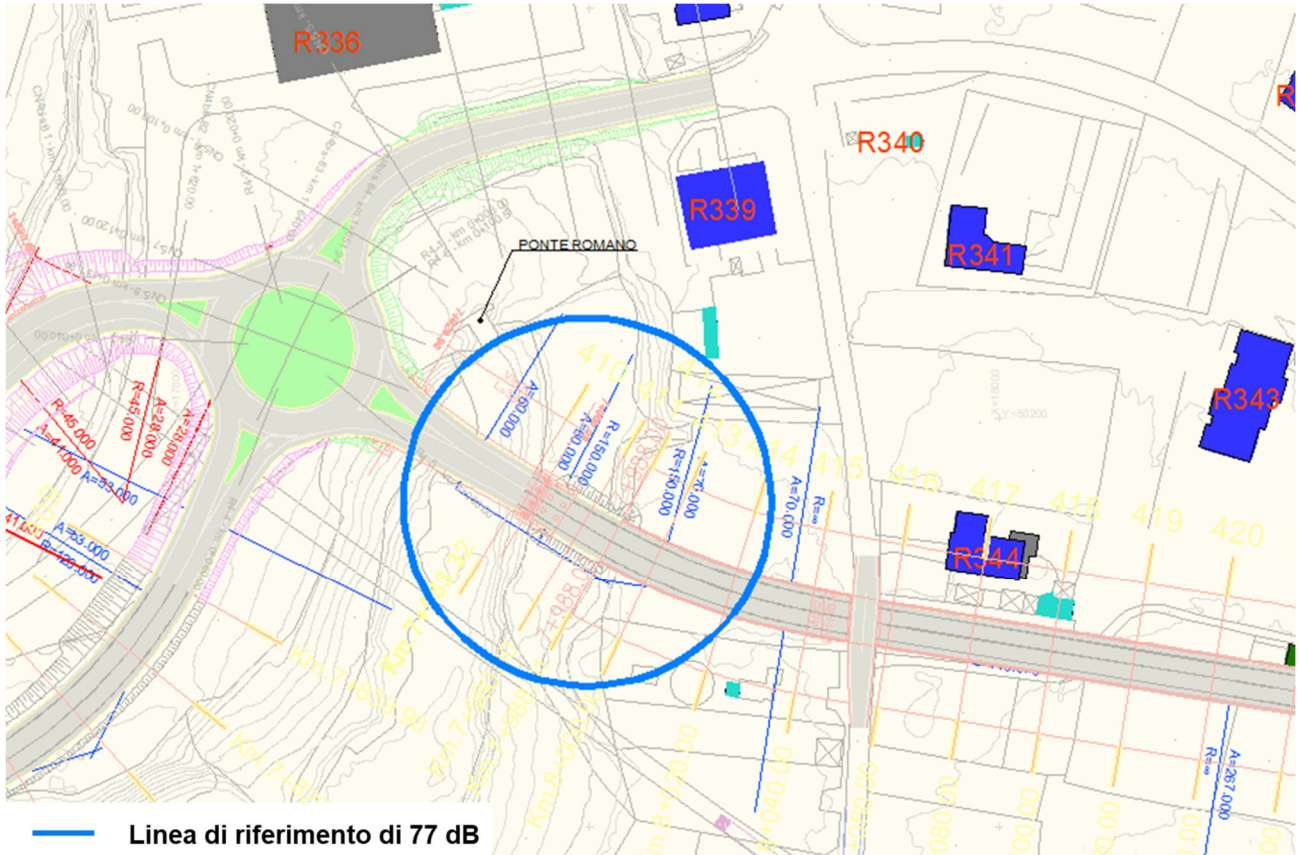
Stralcio planimetrico con indicazione della linea di riferimento dei 77 dB per il Viadotto VI.001 a Barisciano
